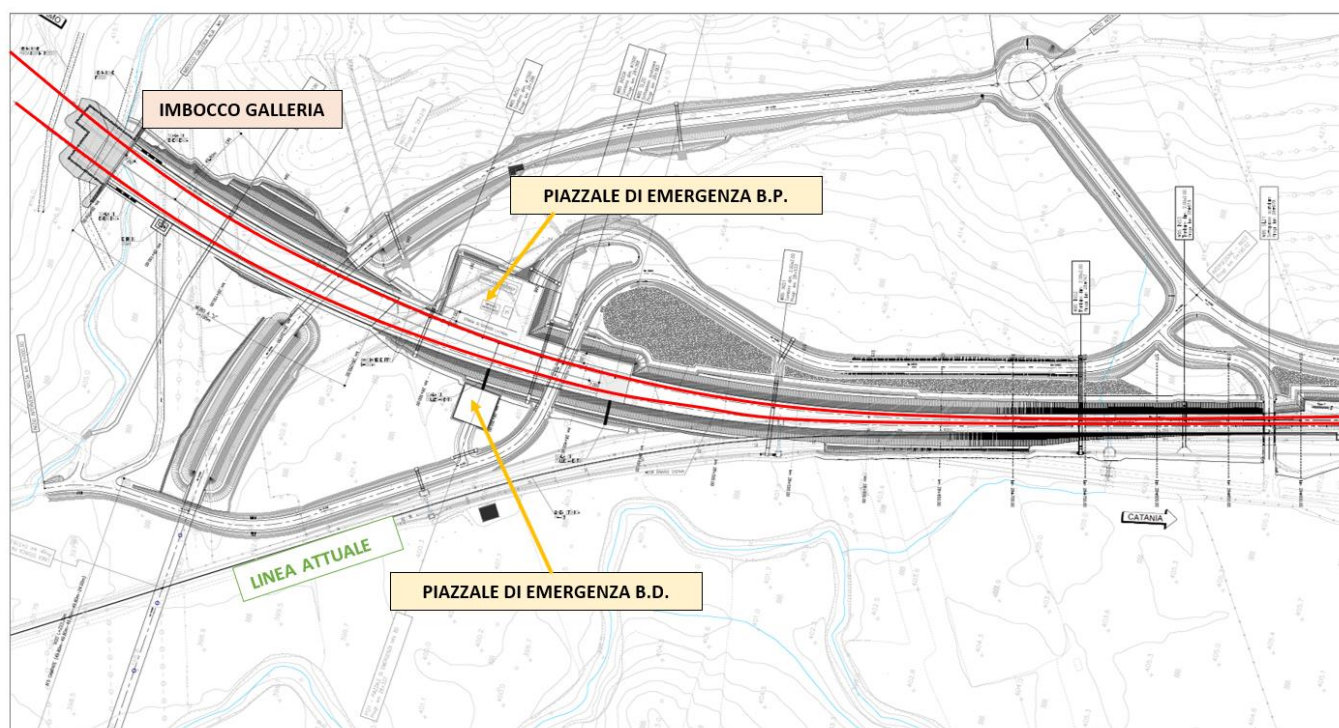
Assetto planimetrico opere zona di imbocco galleria lato Catania
